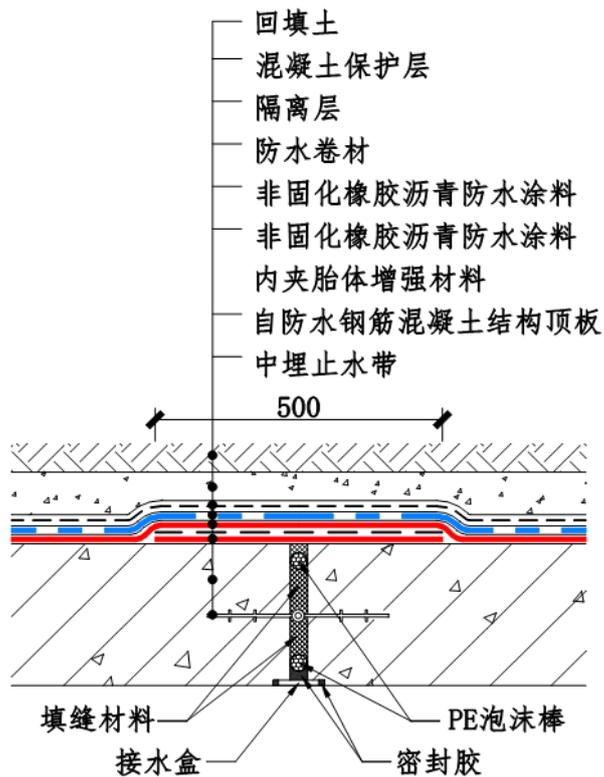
顶板变形缝复合防水构造 (一)
